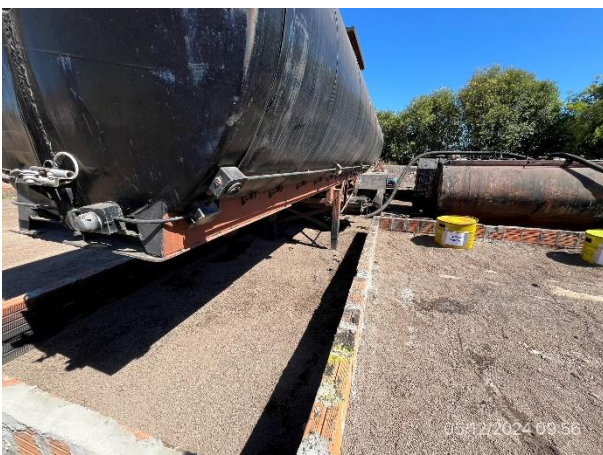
, P03. Planta asfáltica, envasado perimetral adecuado para contener eventuales derrames.
